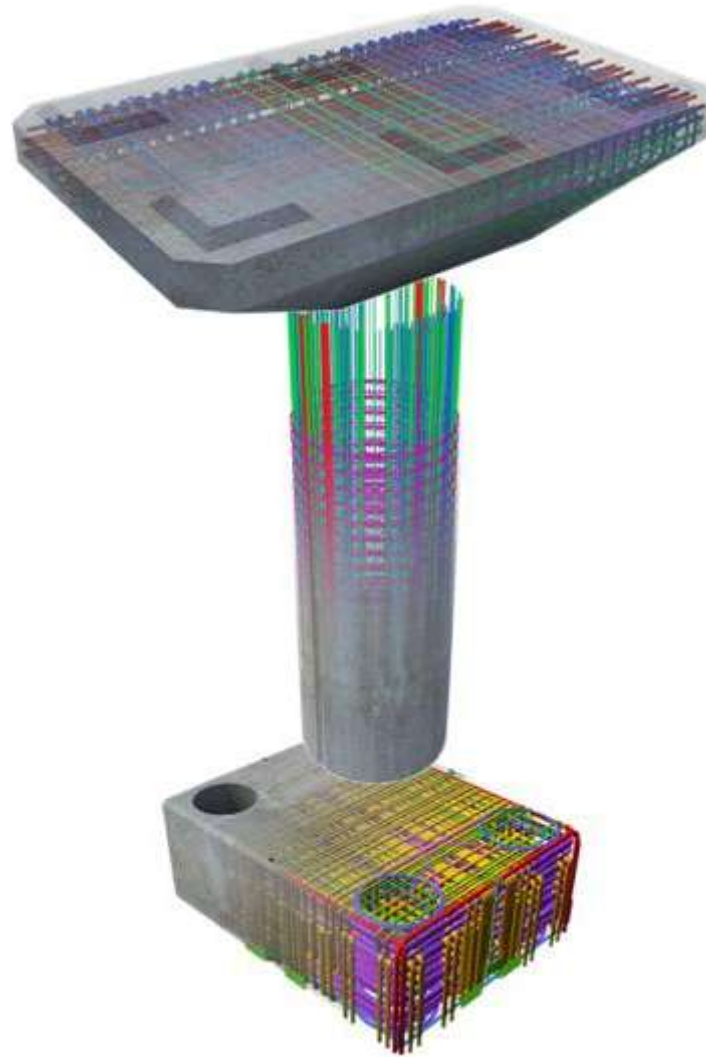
Diseño de pieza prefabricada zapata-columna-capitel.
